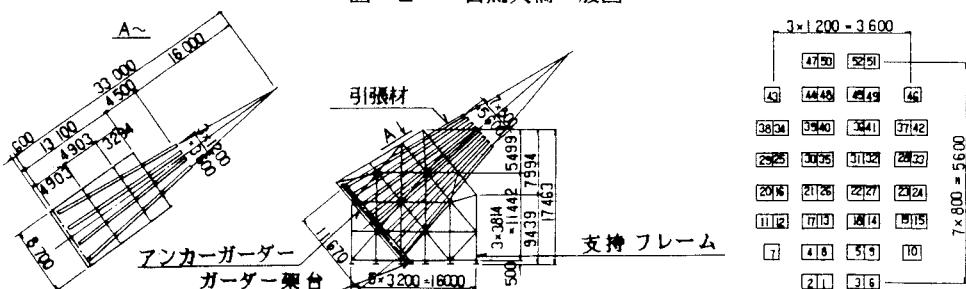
ケーブルアンカーフレーム一般図及びストランド、引張材配置図
